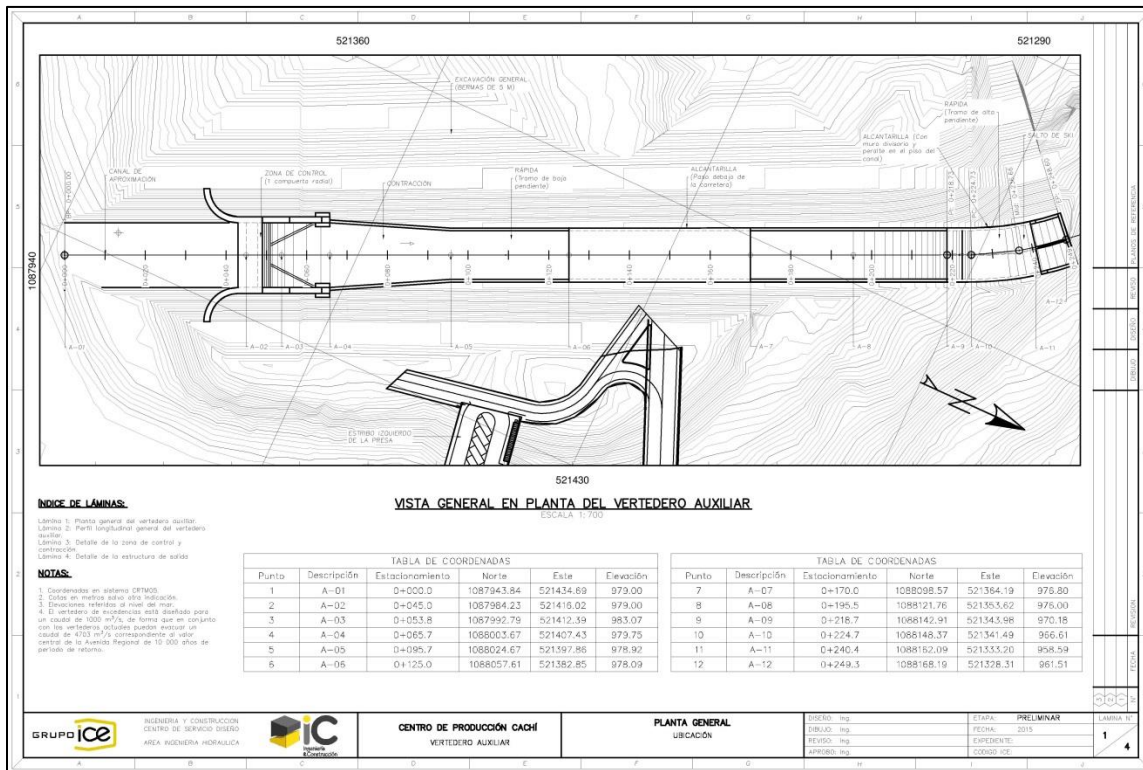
Lámina 1 del vertedero auxiliar: Planta general
